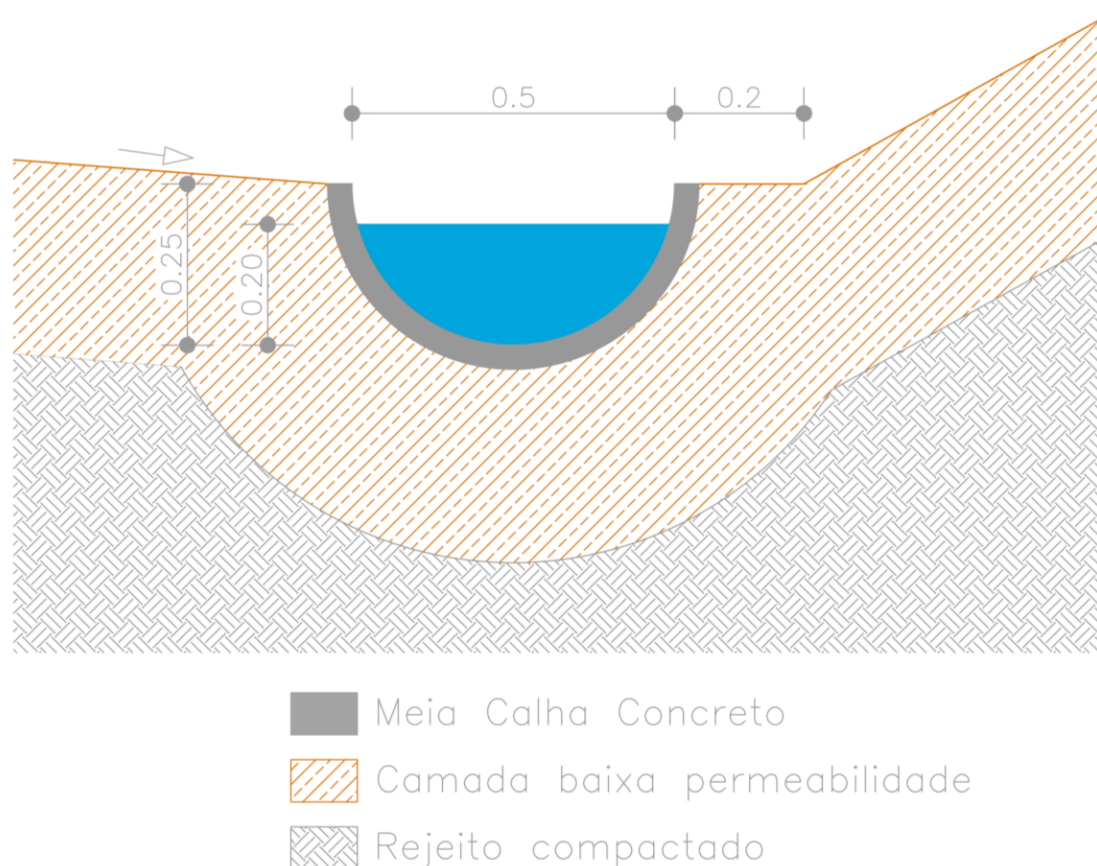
Drenagens das Bermas em concreto pré-moldado semicircular de Ø50 cm.
